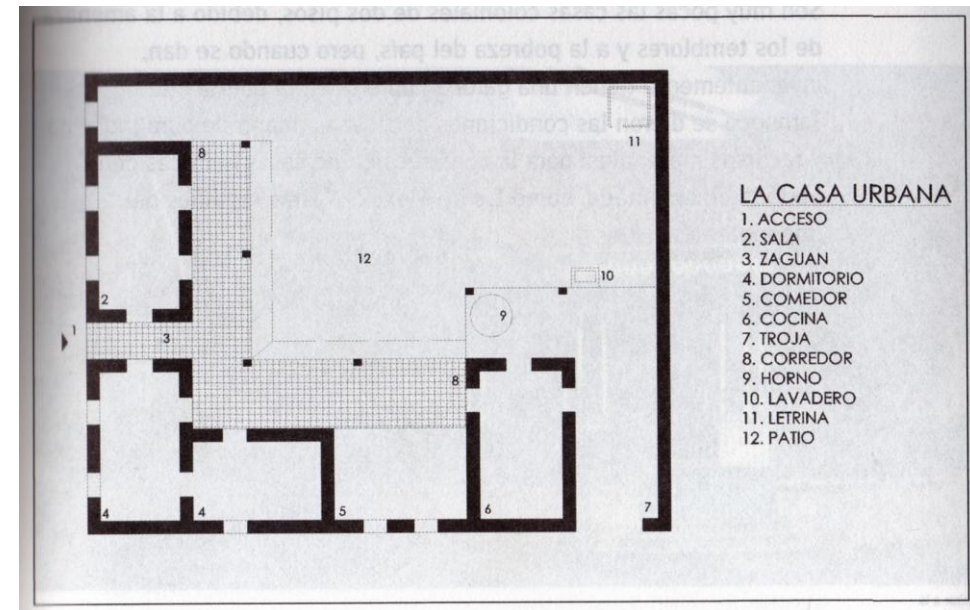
Planta de casa de adobe colonial urbana.
